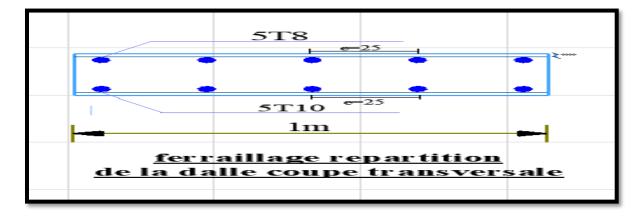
Ferraillage répartition de la dalle Coupe transversale du tablier
